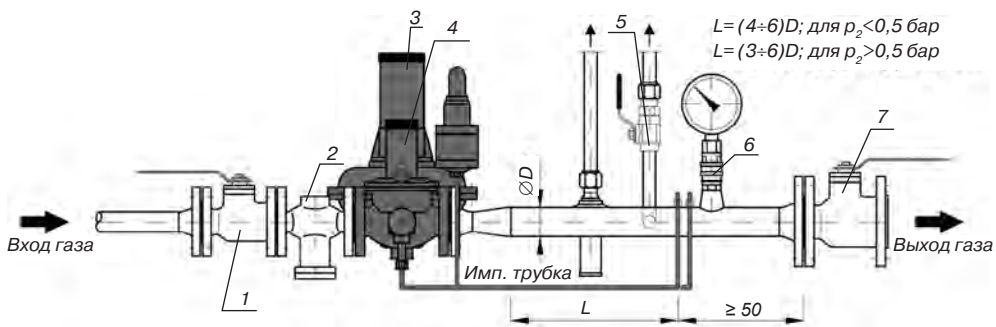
1 — запорное устройство на входе; 2 — фильтр; 3 — регулятор давления типа 131-BV; 4 — предохранительный клапан; 5 — продувочный кран; 6 — запорно-сбросной клапан для манометра; 7 — запорное устройство на выходе
